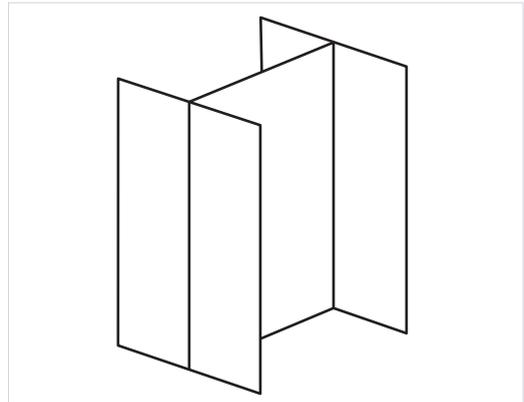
Pilar metálico Nivel de desarrollo 200. Fuente: BIM Forum 2013, B 1010.10\_Floor Structural Frame\_Steel Framing Columns
